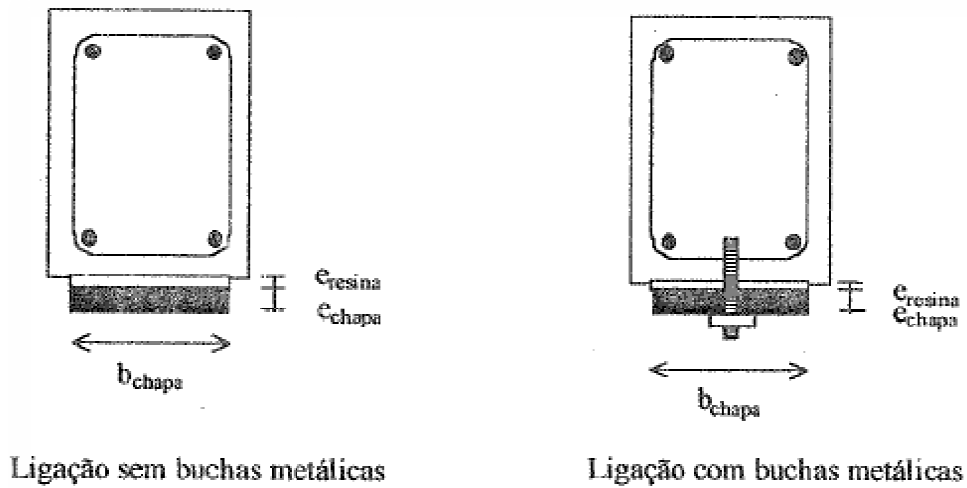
Reforço de vigas com recurso a chapas metálicas (Carreira, 2000).
